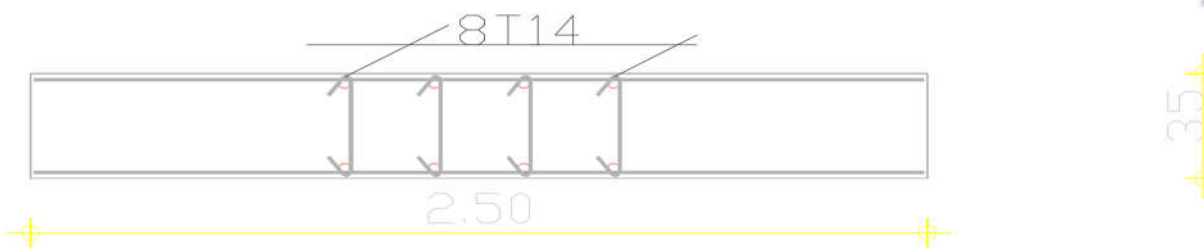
ferrailage pour la voile de la cage d'escalier (voiles 3y) en zone d'about
